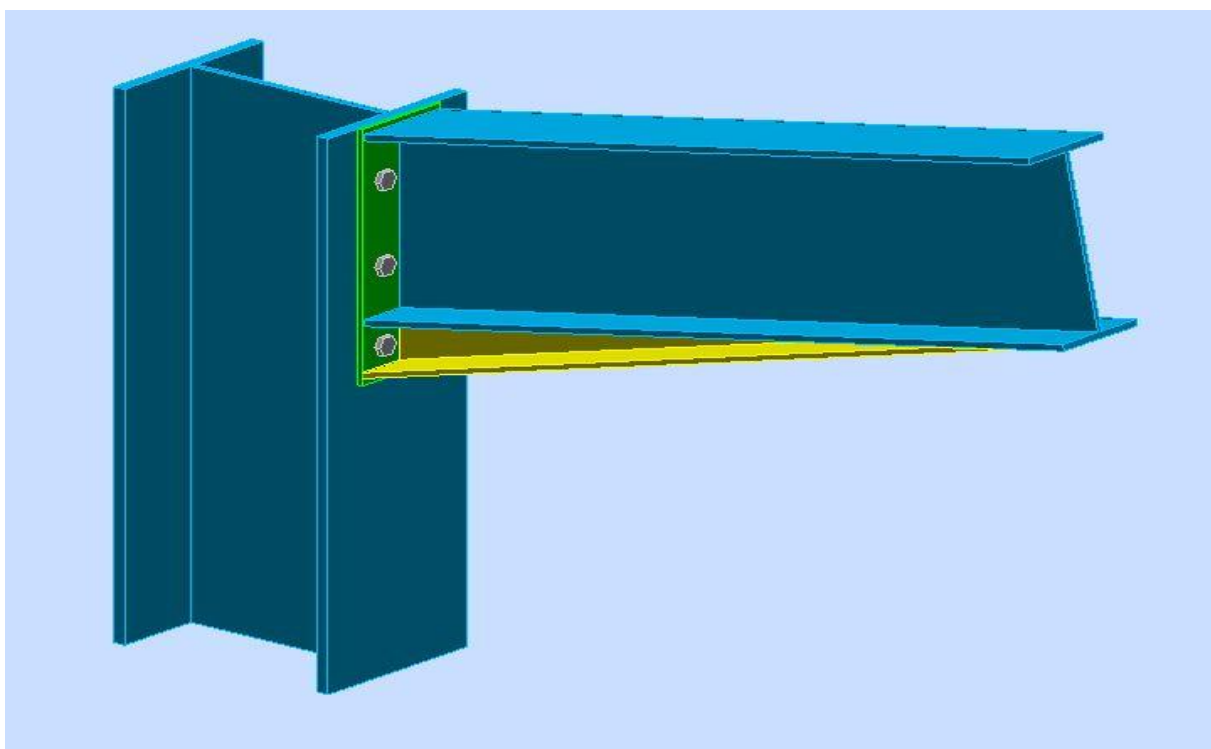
Vue 3D de l'assemblage poteau traverse IPE 330.
